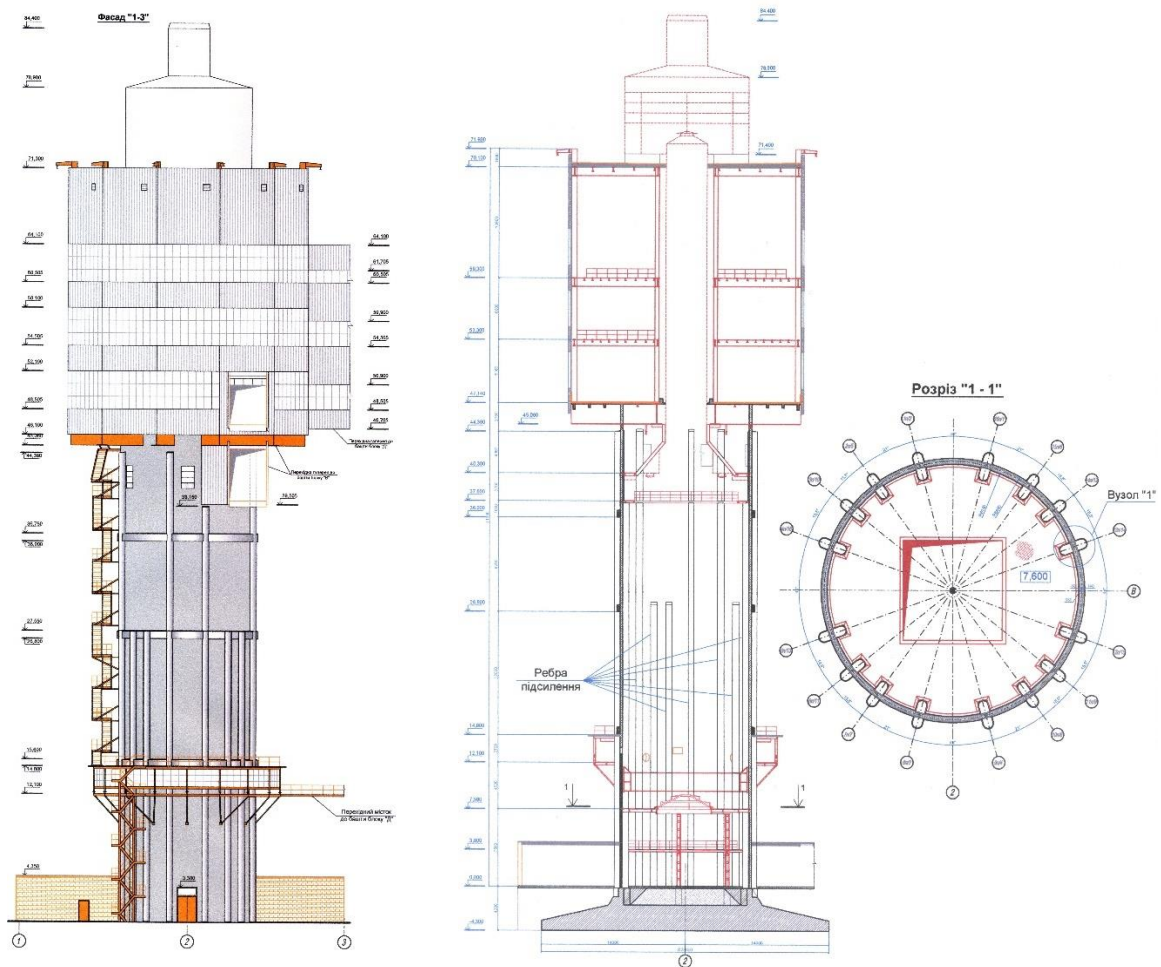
Фасад та поздовжній і поперечний розрізи бапти гранулювання аміачної селітри
